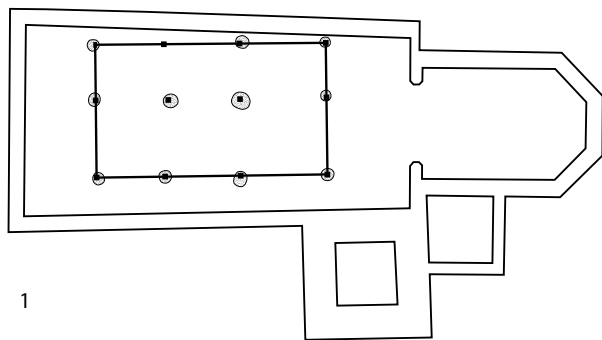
Worb, Kirche. Die Grundrisse der bekannten Bauphasen. M. 1:400.
